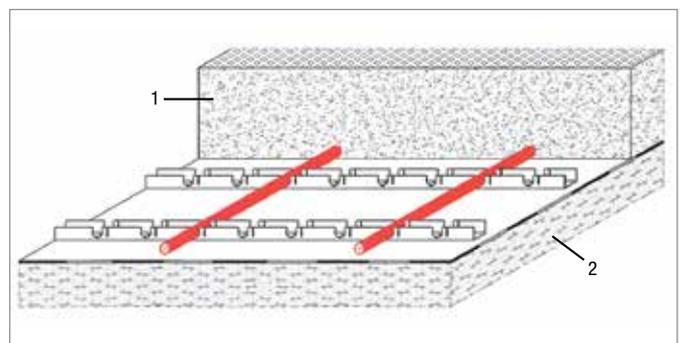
Piano di fondazione in cemento armato con fibre d'acciaio; costruzione standard con tubi di riscaldamento montati su binari di fissaggio
